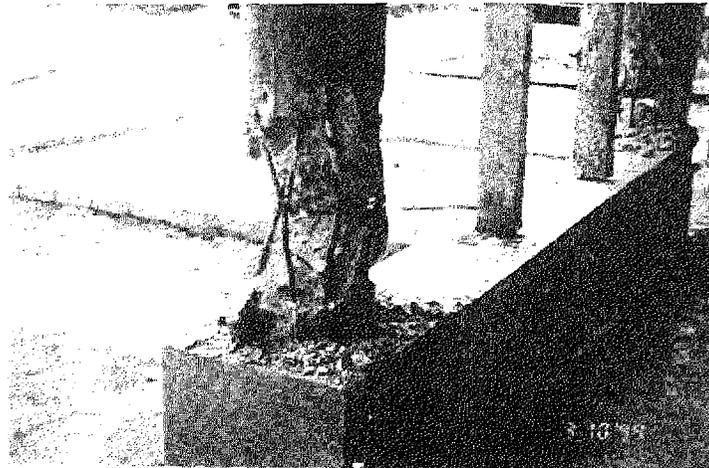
Detalle del daño en las columnas del edificio que además muestra el escaso refuerzo transversal (estribos)
